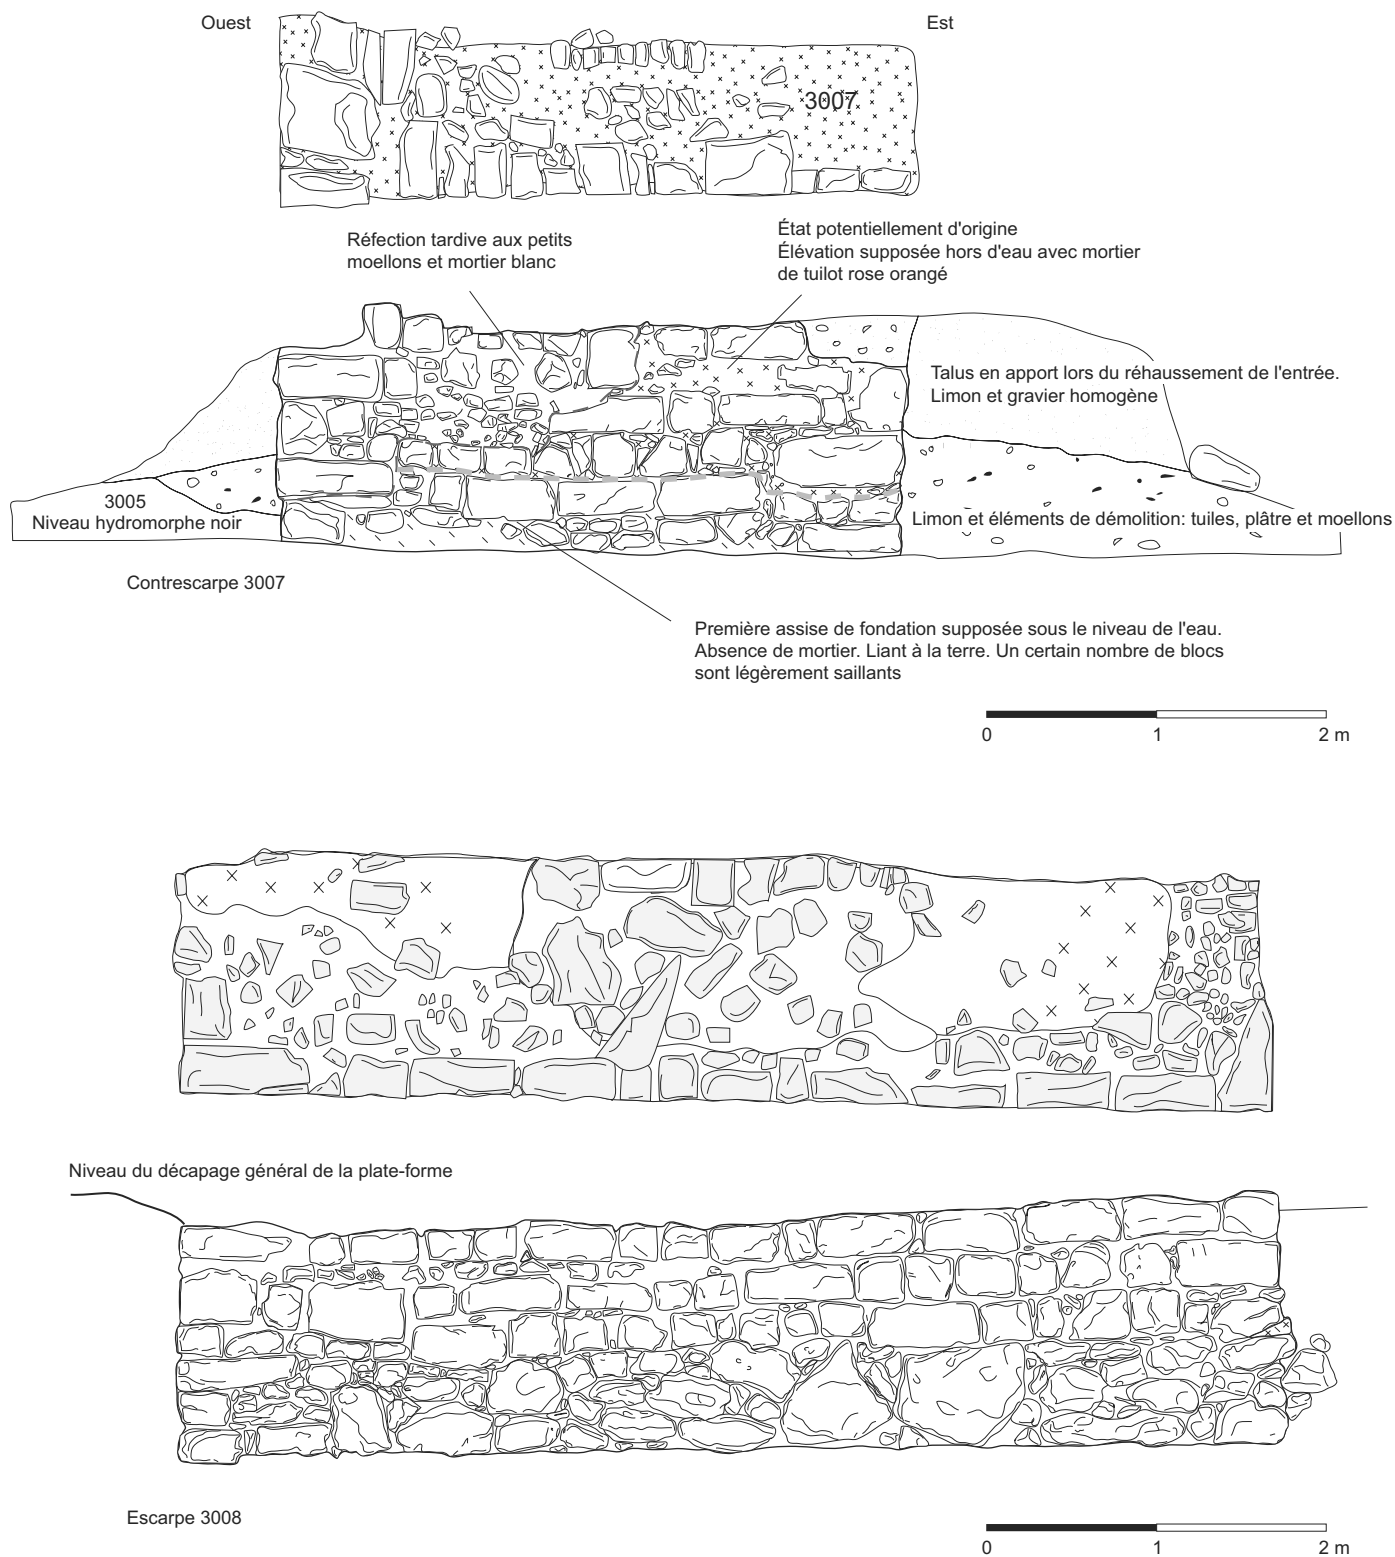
Plan masse et élévation de la contrescarpe 3007 et de l'escarpe maçonnée 3008 © S. Hurard.
